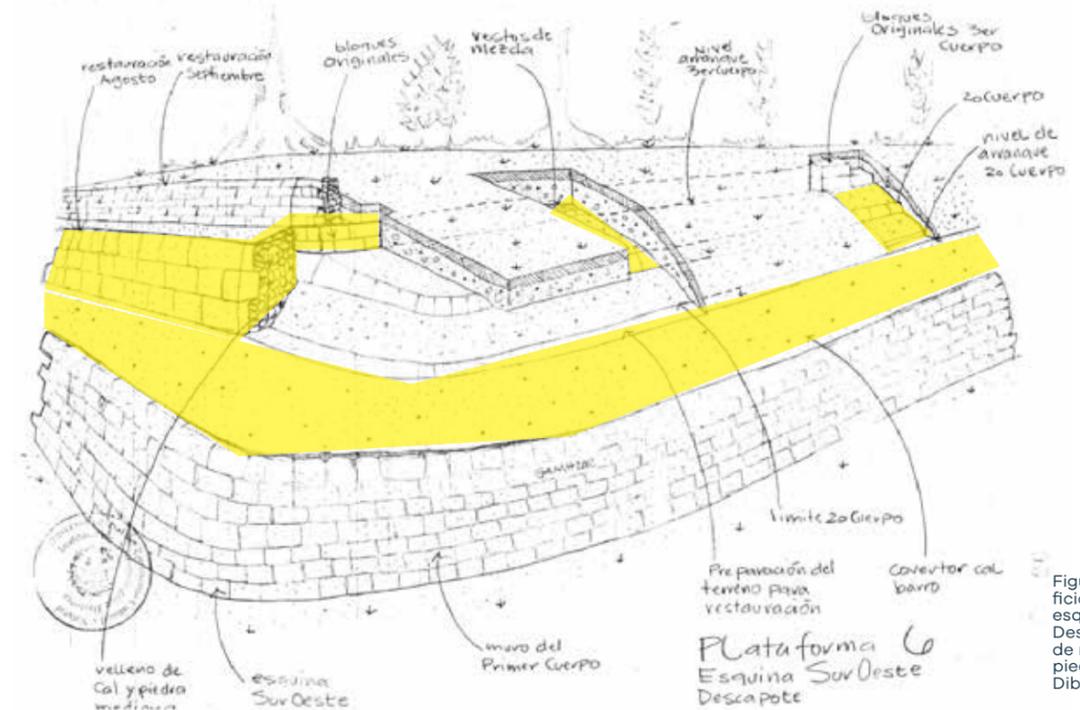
Dibujo Edificio 6 Fachada sur, esquina sur oeste, Descapote e integración de núcleo y fachada de piedra. Dibujo: GAMH 2002
